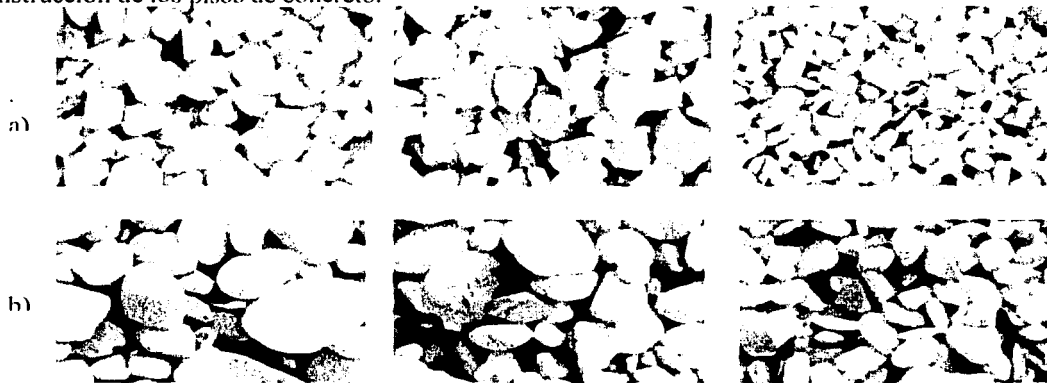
a) Gravas de canto angulado propicio para el diseño de mezclas en pisos industriales b) gravas de canto redondeado idóneas para estructuras con bajos índices de especificación.
